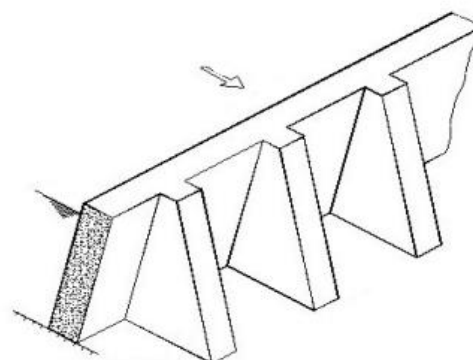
Esquema da geometria de uma barragem de concreto construída pelos sistemas de gravidade e contrafortes. Fonte: Adaptado de VIEIRA JUNIOR e SALLES (2011), *apud* Possan, [201-].
